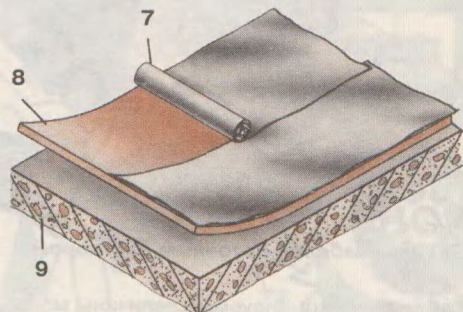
Укладка слоя теплоизоляции и алюминиевой фольги на основание.
